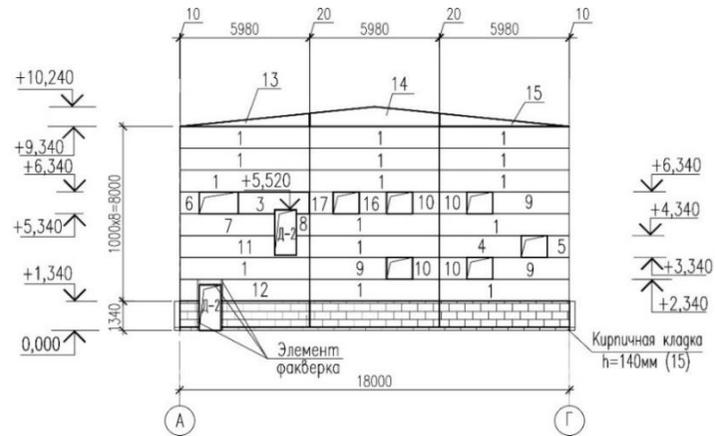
«Схема раскладки сэндвич-панелей на фасаде А-Г» [40]
